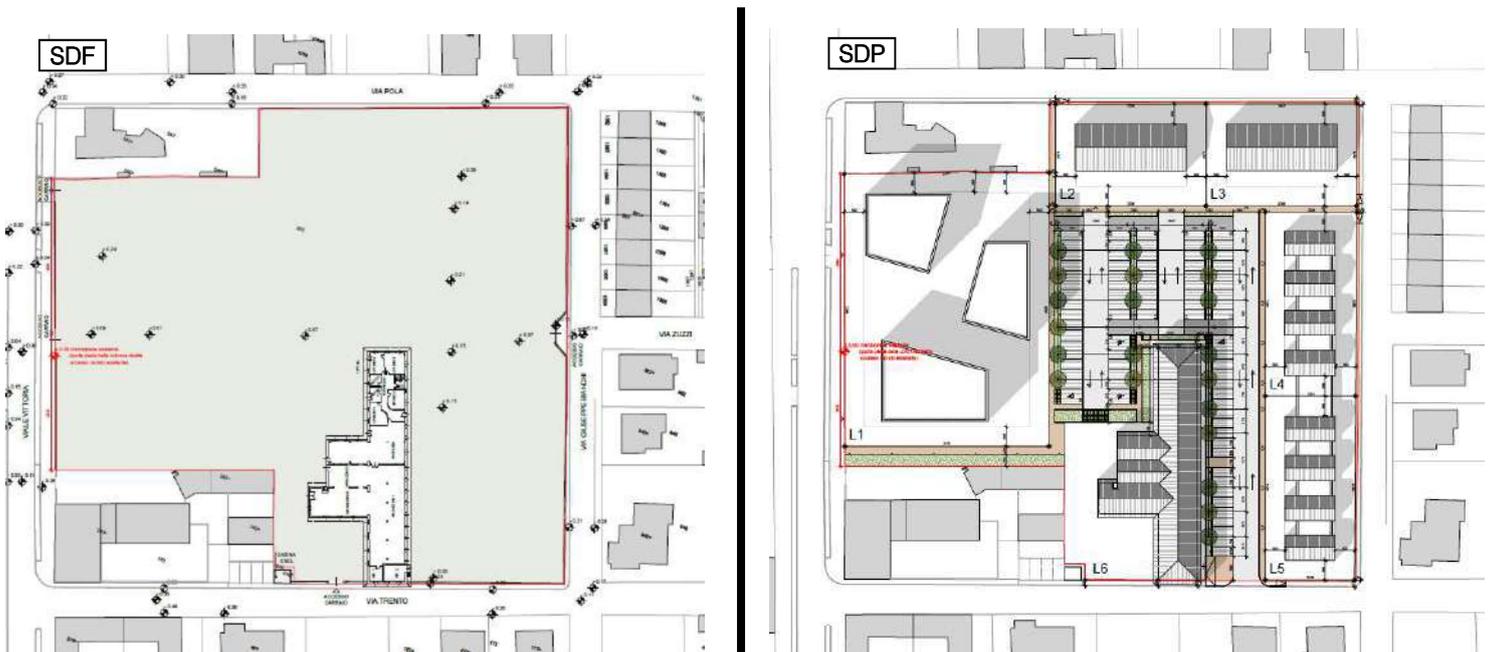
Planimetrie “!Stato di fatto” e “Stato di Progetto”.
